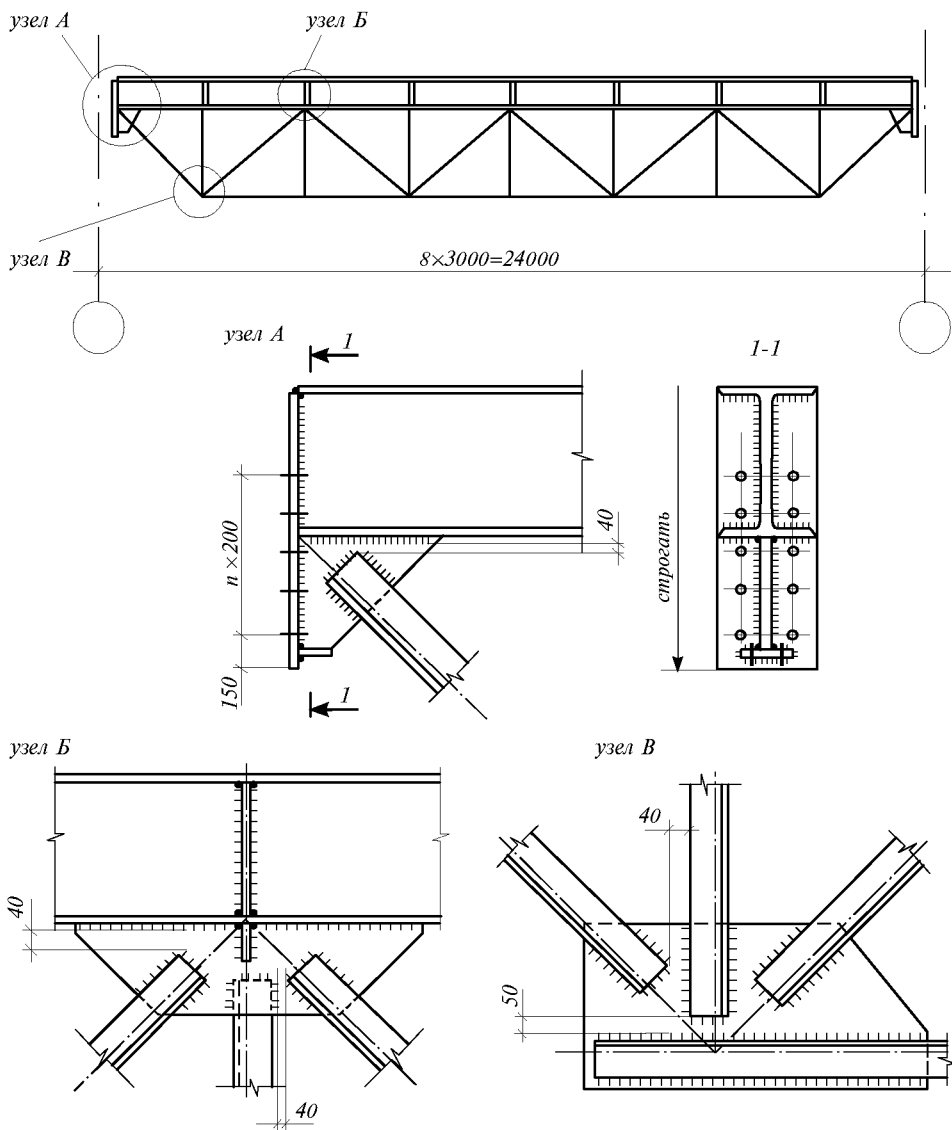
Сварные узлы подкрановых ферм
